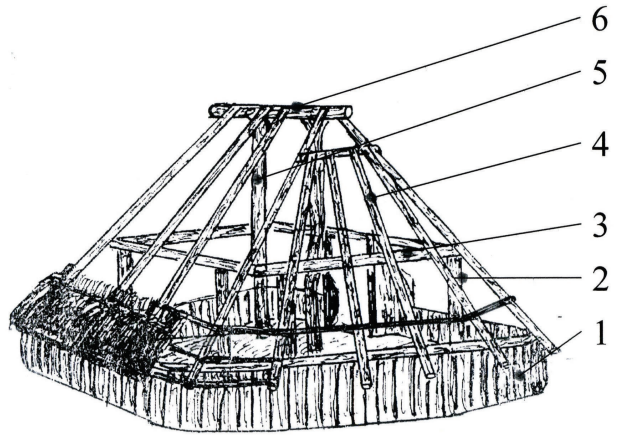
Schemazeichnung des Hauses 13A. 1. Spaltbohlen; 2. Pfettenpfosten; 3. Pfettenkranz; 4. Sparren; 5. Firstständer; 6. Firstpfette.
